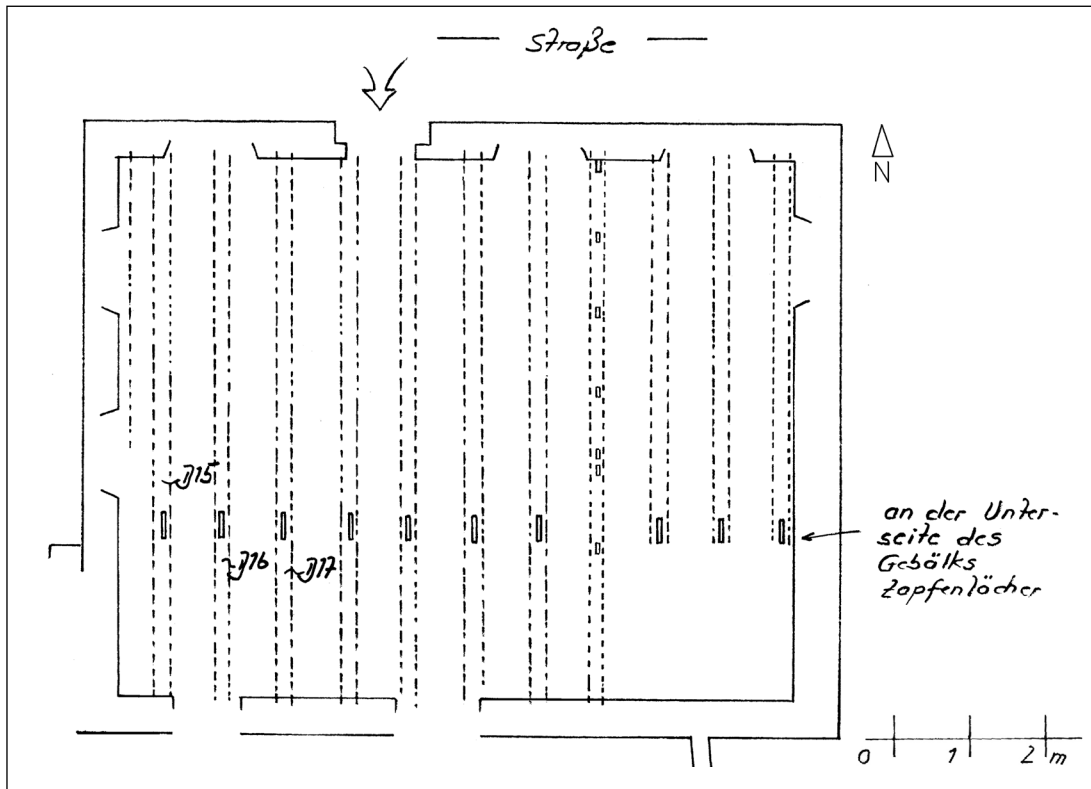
Hauptstraße 65, Grundriss Erdgeschoss.
